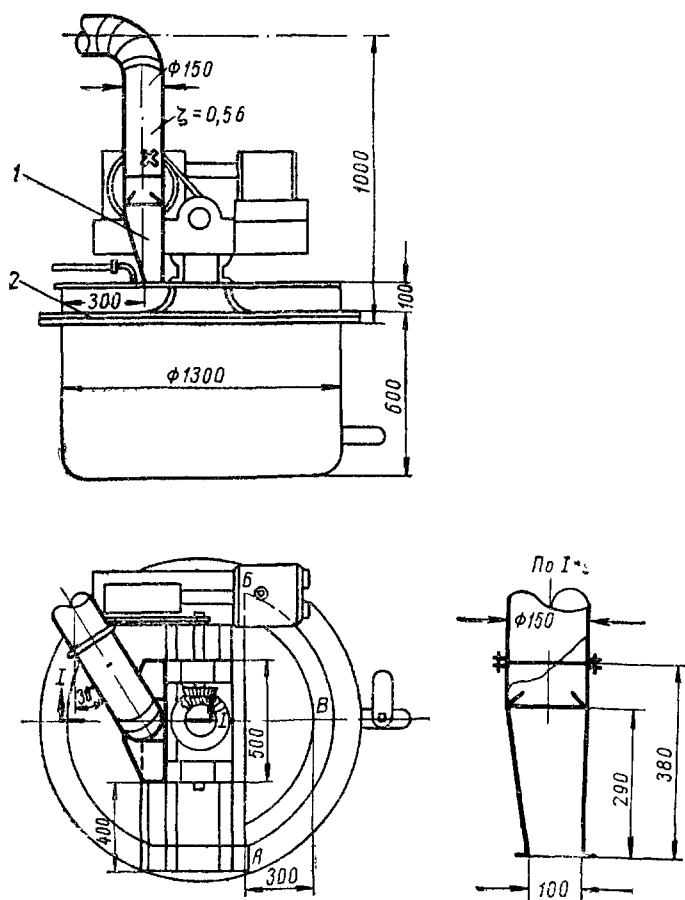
Местный отсос от клеварочного котла с механической мешалкой
